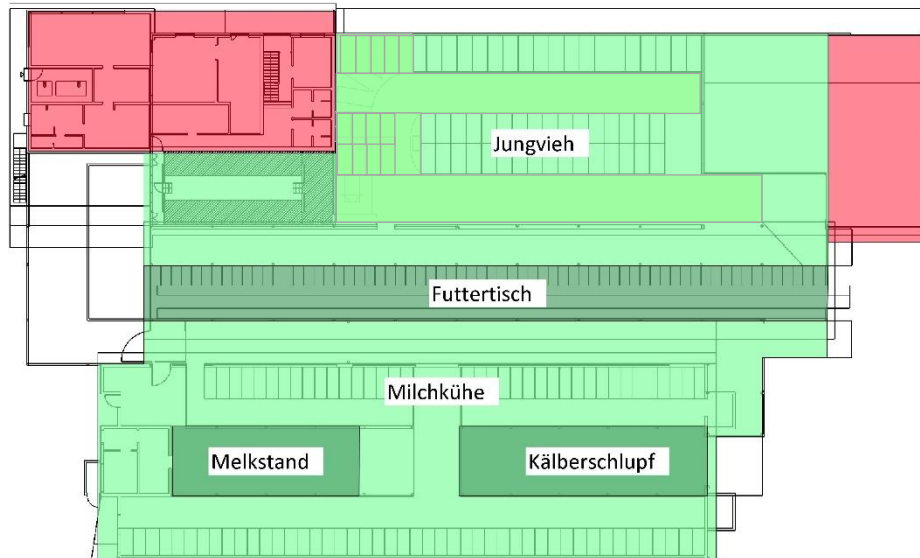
Einteilung des Stalles vor dem Umbau mit Bestand (grün) und geplanter Erweiterung (rot)
